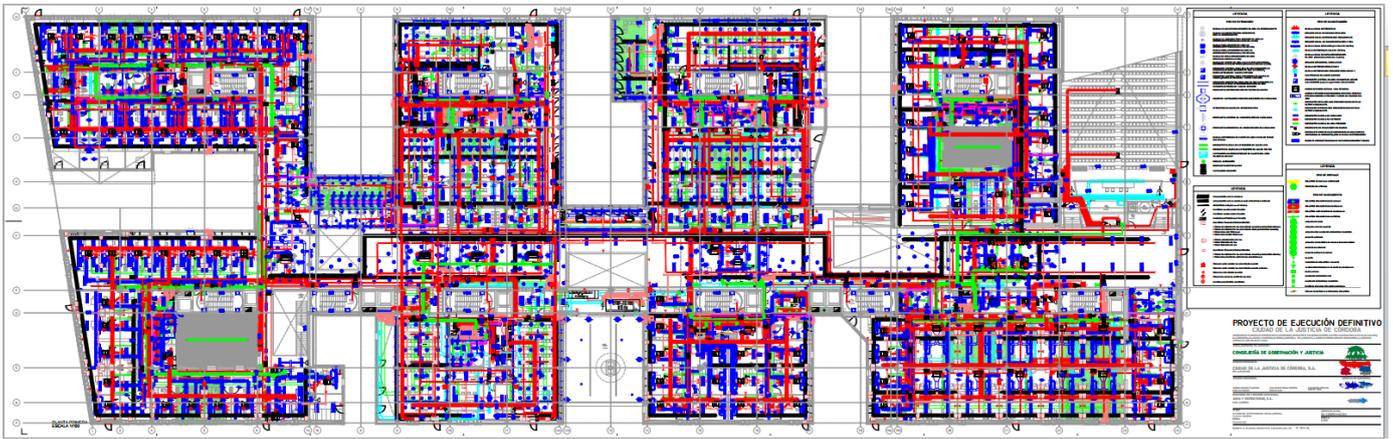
Plano de coordinación de las instalaciones MEP y arquitectura (planta primera, M1, M2, M3, M4).
